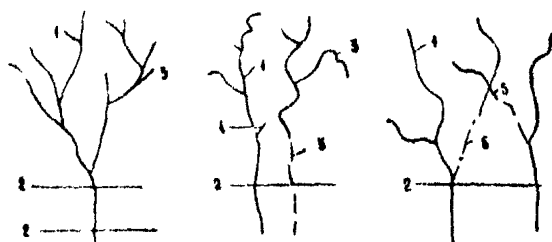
Схема возможных пересечений водотоков в местах слияния нескольких притоков: 1-основной водоток; 2-варианты проложения дорог; 3-приток; 4-искусственное русло после спрямления; 5-русло водотока до спрямления или прорыва; 6-русло, образованное при прорыве или свале с конуса выноса.
